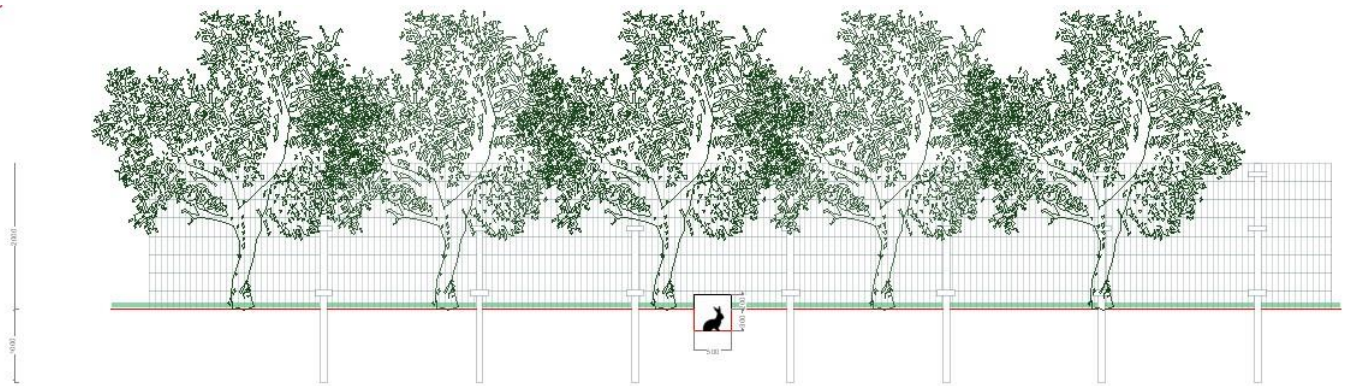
Tipico fascia perimetrale a verde e passaggi faunistici
